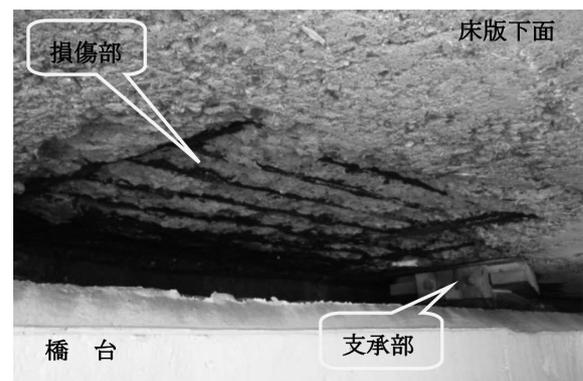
施工対象橋梁の狭隘部の塩害損傷状況
